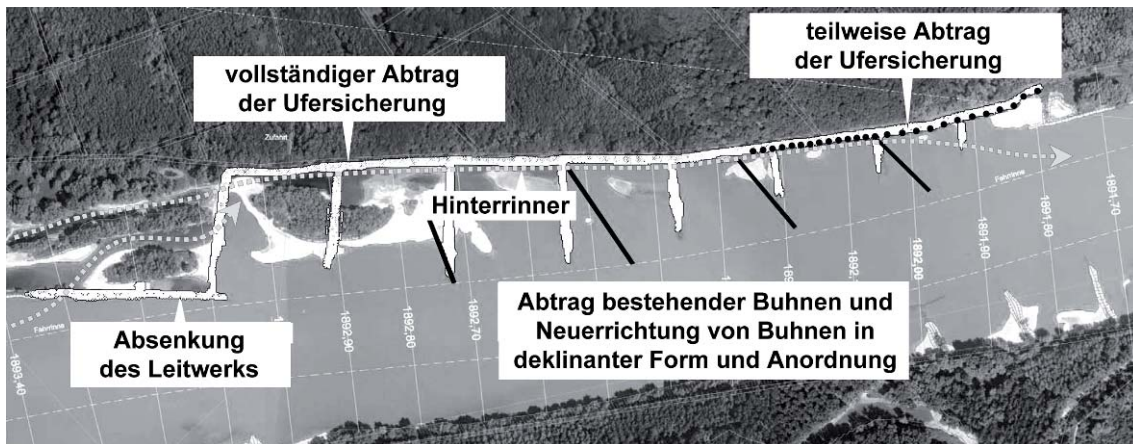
Pilotprojekt Witzelsdorf, Lageplan.
